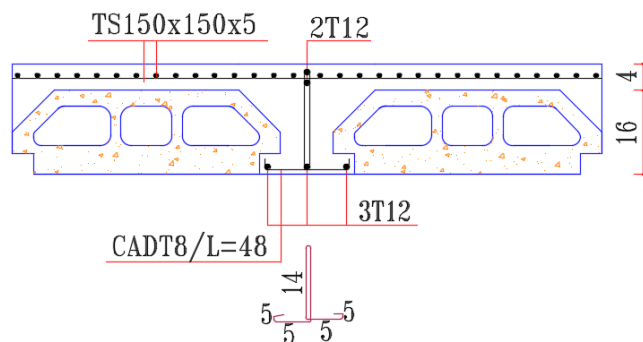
Schéma de ferrailage de la poutrelle sur Appuis
